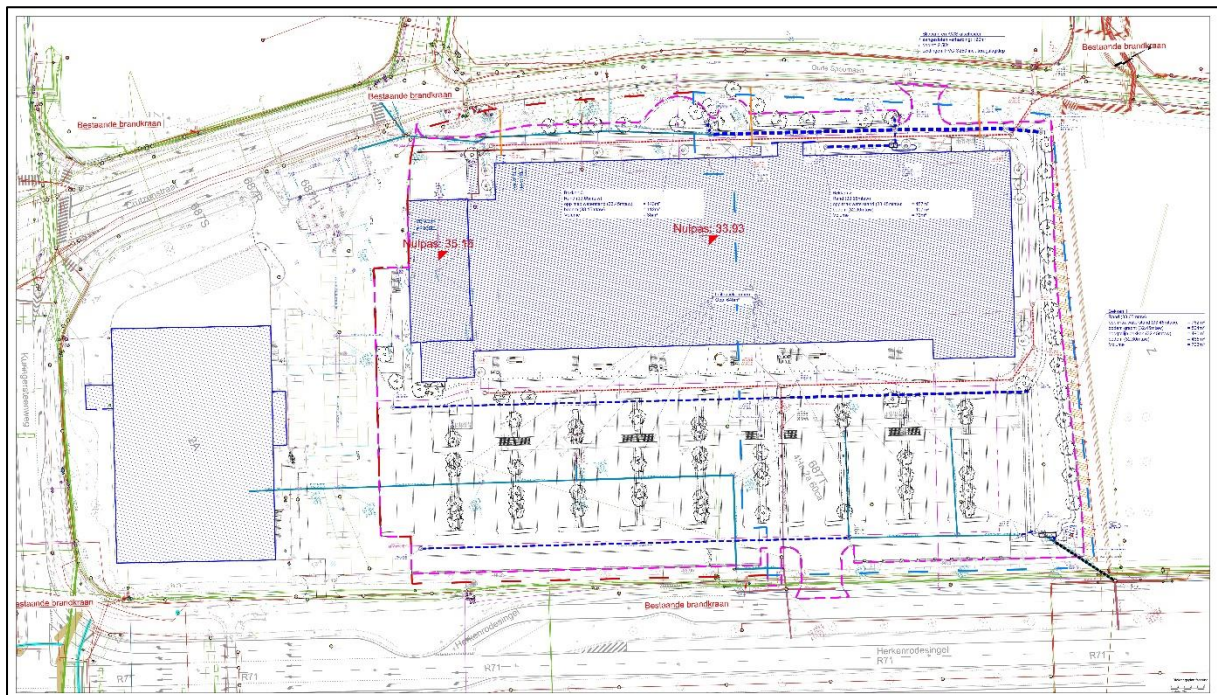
Opmetingsplan bestaande toestand (Bron: opdrachtgever, aanmaatschaal 1:250, 19/05/2025; BIJLAGE 3).
